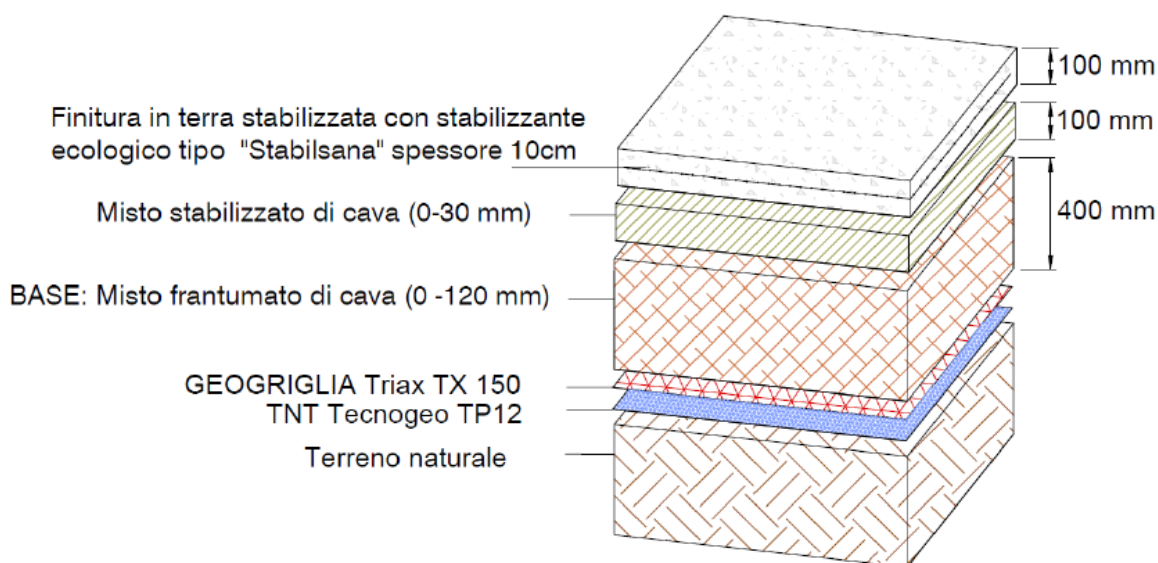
Tipico pacchetto stradale di Progetto – tratti a forte pendenza
